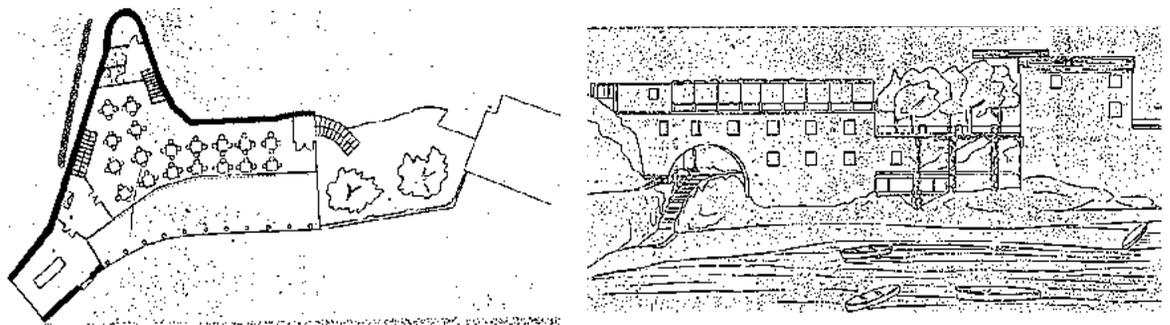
Luigi Vietti. Piante e prospetto dell'albergo San Fruttuoso (1937).
